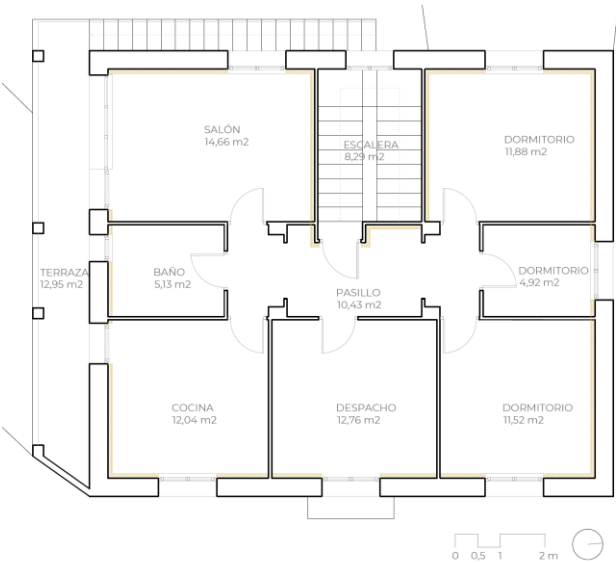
Planta primera de la vivienda rehabilitada. Fuente: Elaboración propia.
